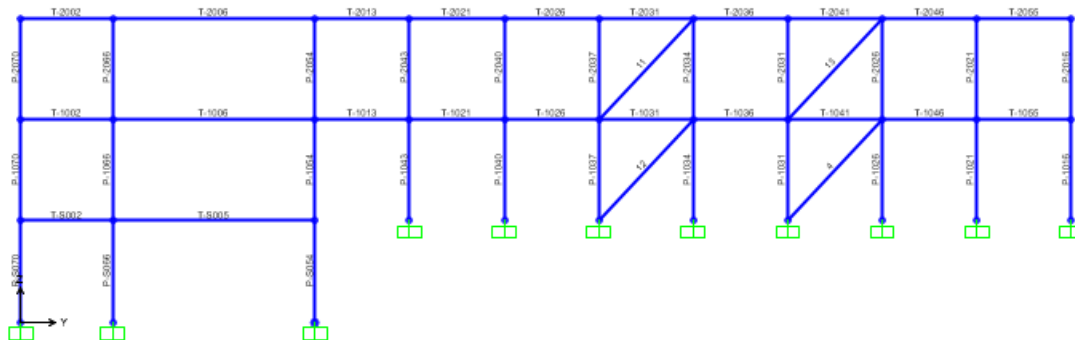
Disposizione dei controventi nel Telaio 1.
